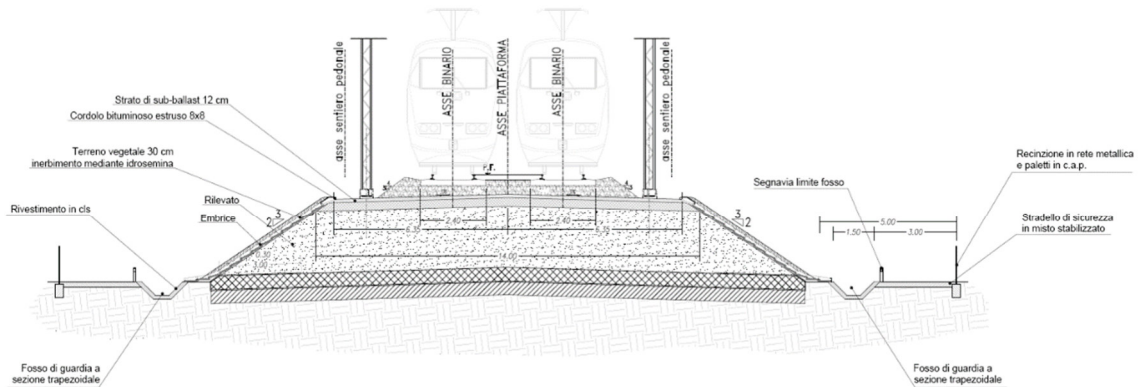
Sezione ferroviaria in rilevato a doppia linea
